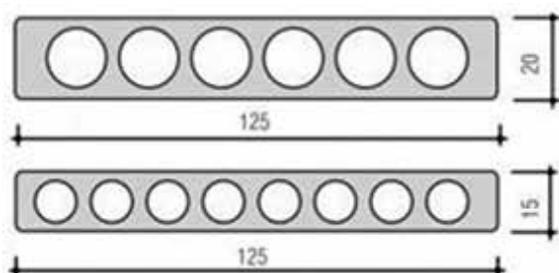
Seção transversal de um painel alveolar com largura e espessuras típicas. (CASSOL, 2012)
